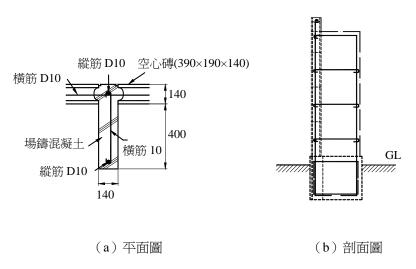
扶壁爲場鑄鋼筋混凝土造之配筋圖
